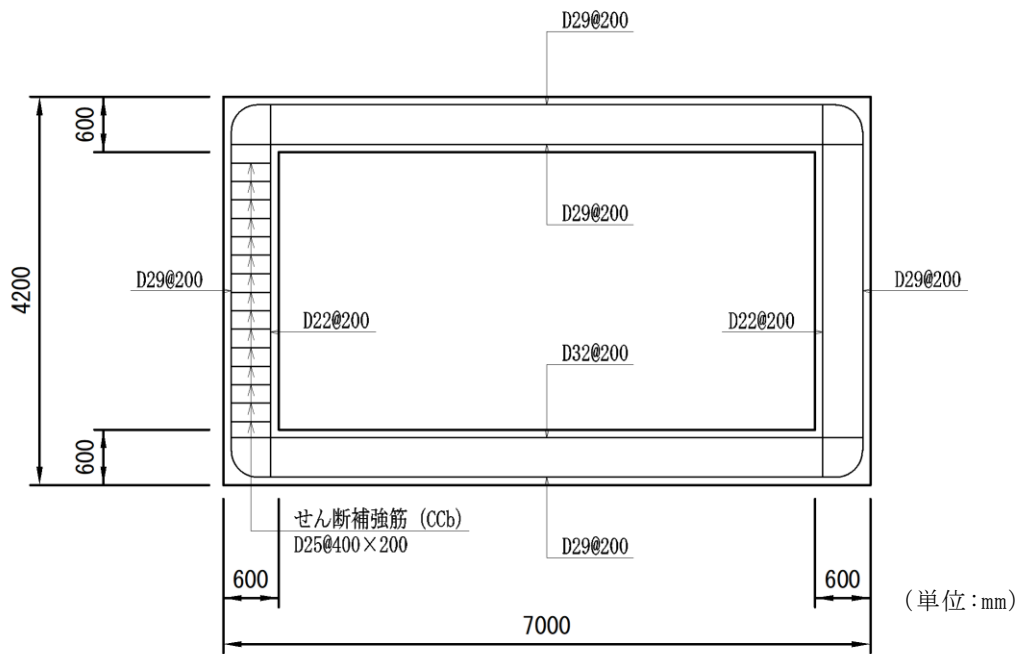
屋外配管ダクト (タービン建物～放水槽) 概略配筋図 (A-A 断面)
